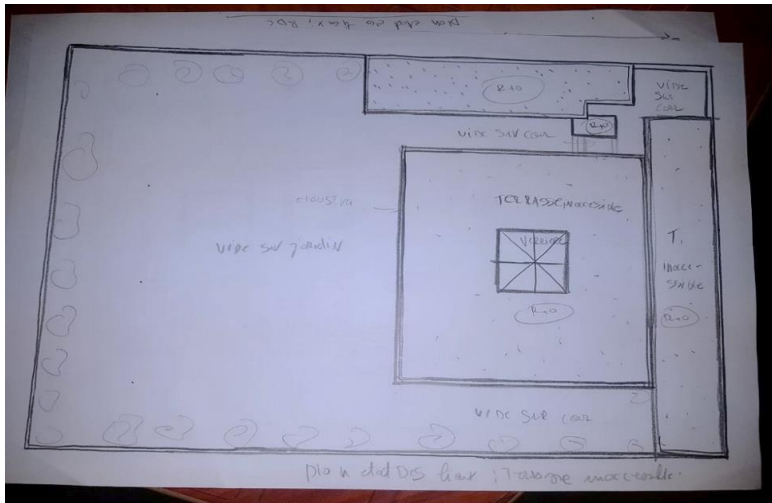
Dessin a main levée du plan état des lieux : terrasse inaccessible
